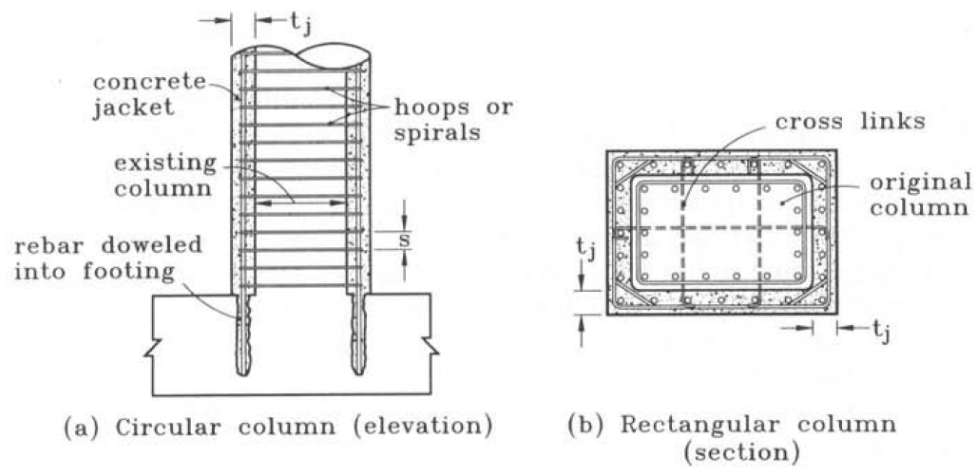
Esquema del refuerzo de pilares mediante encamisados de hormigón armado³.
